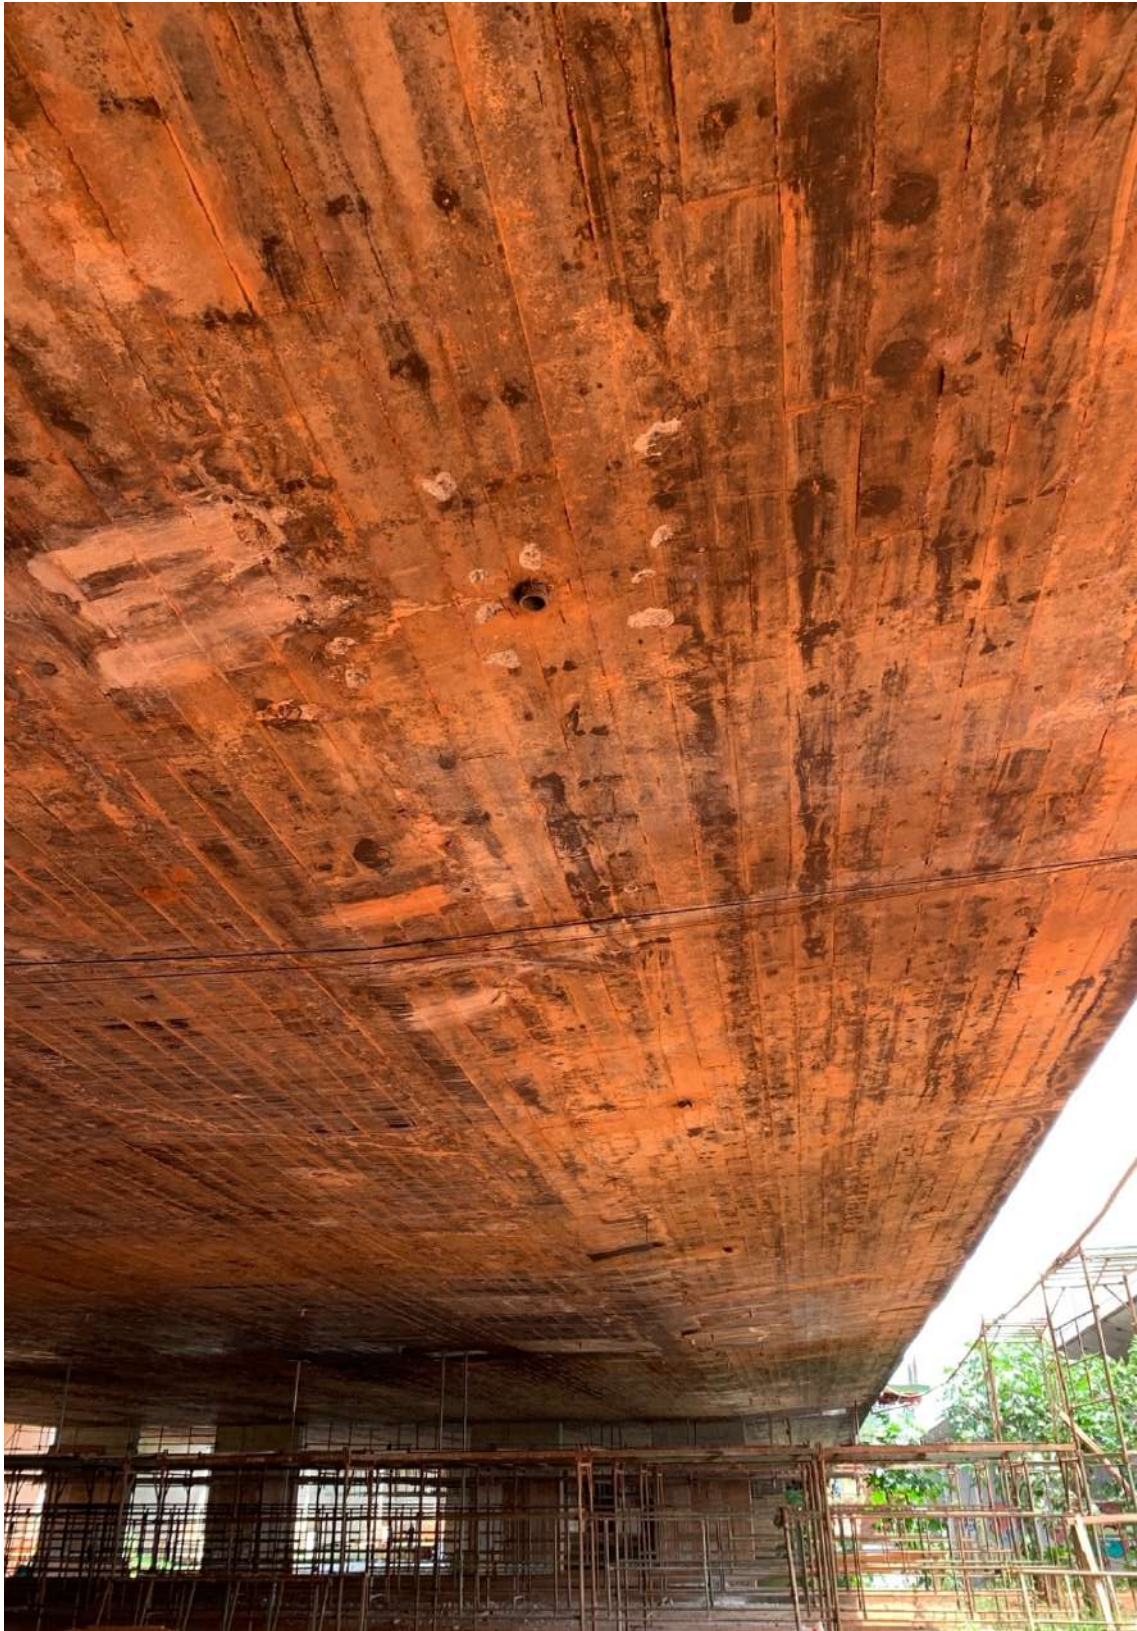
Recuperação da laje inferior da ponte do Braghetto durante o processo de Retrofit, ambiente externo. Fonte: autoral
